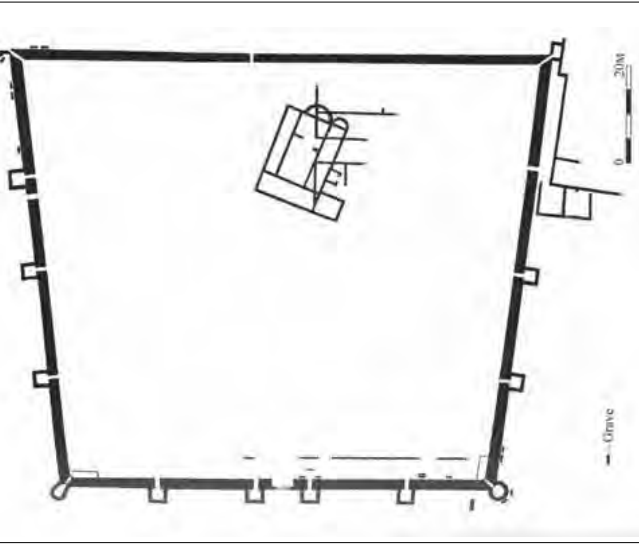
Paleokastër, planimetria della fortificazione (tratto da Baçe 1981, p. 220, tav. II).
